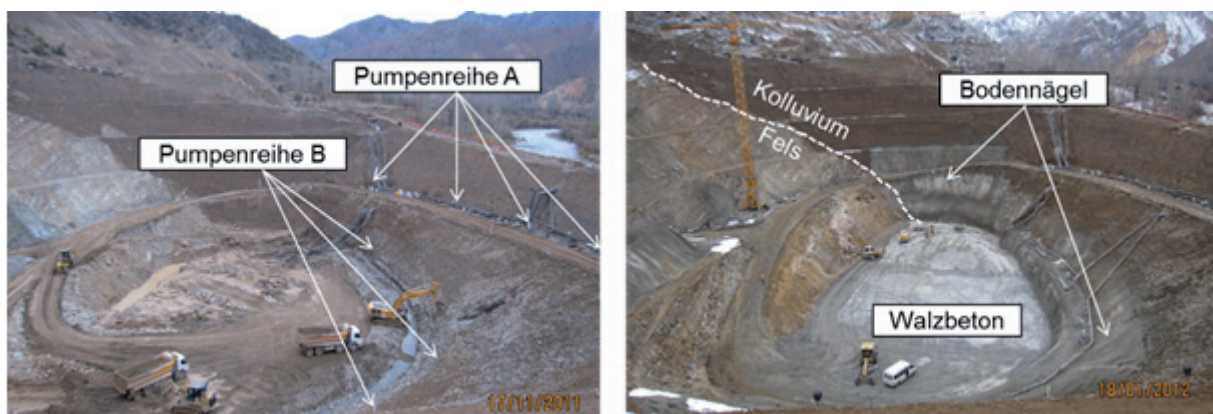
Baugrube vor (links) und nach dem Betonieren (rechts) der Gründung
